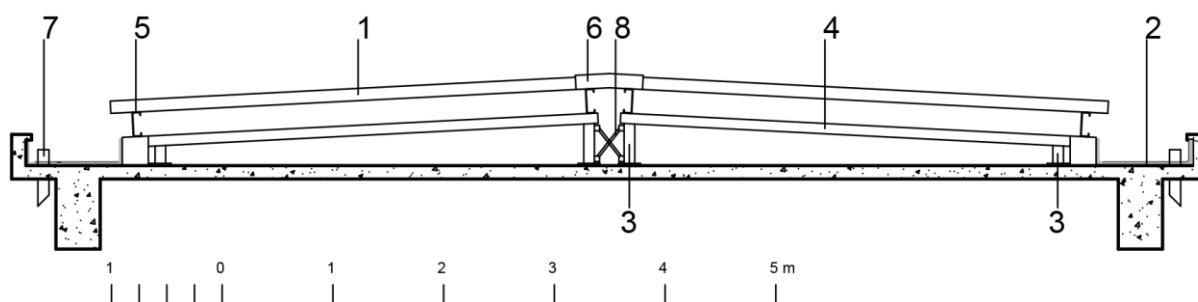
Planta da cobertura com o projeto do telhado do Edifício da Ala Central do I.F. (Fonte: SEF)
